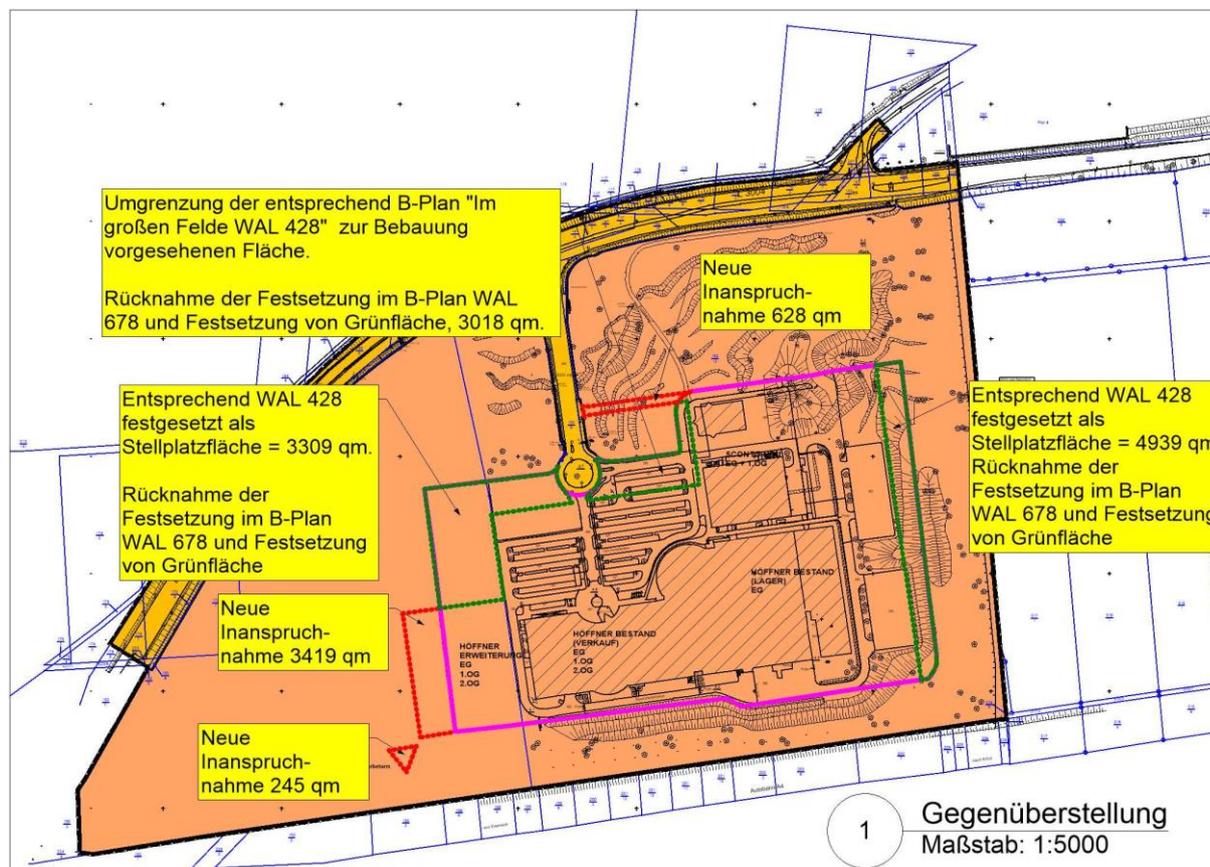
Gegenüberstellung der überbaubaren Flächen WAL 428 und WAL 678
